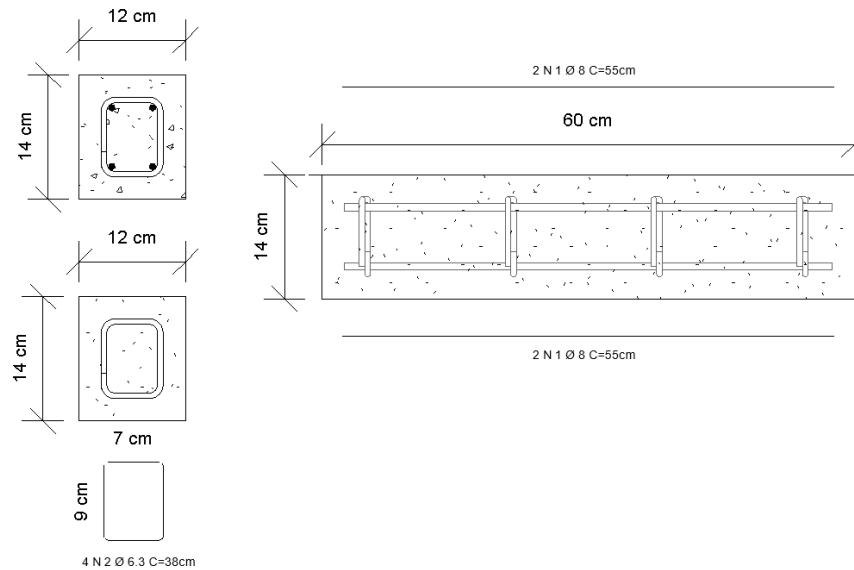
Detalhamento das Vigas de concreto armado com GFRP (Fonte: Autor, 2023)
